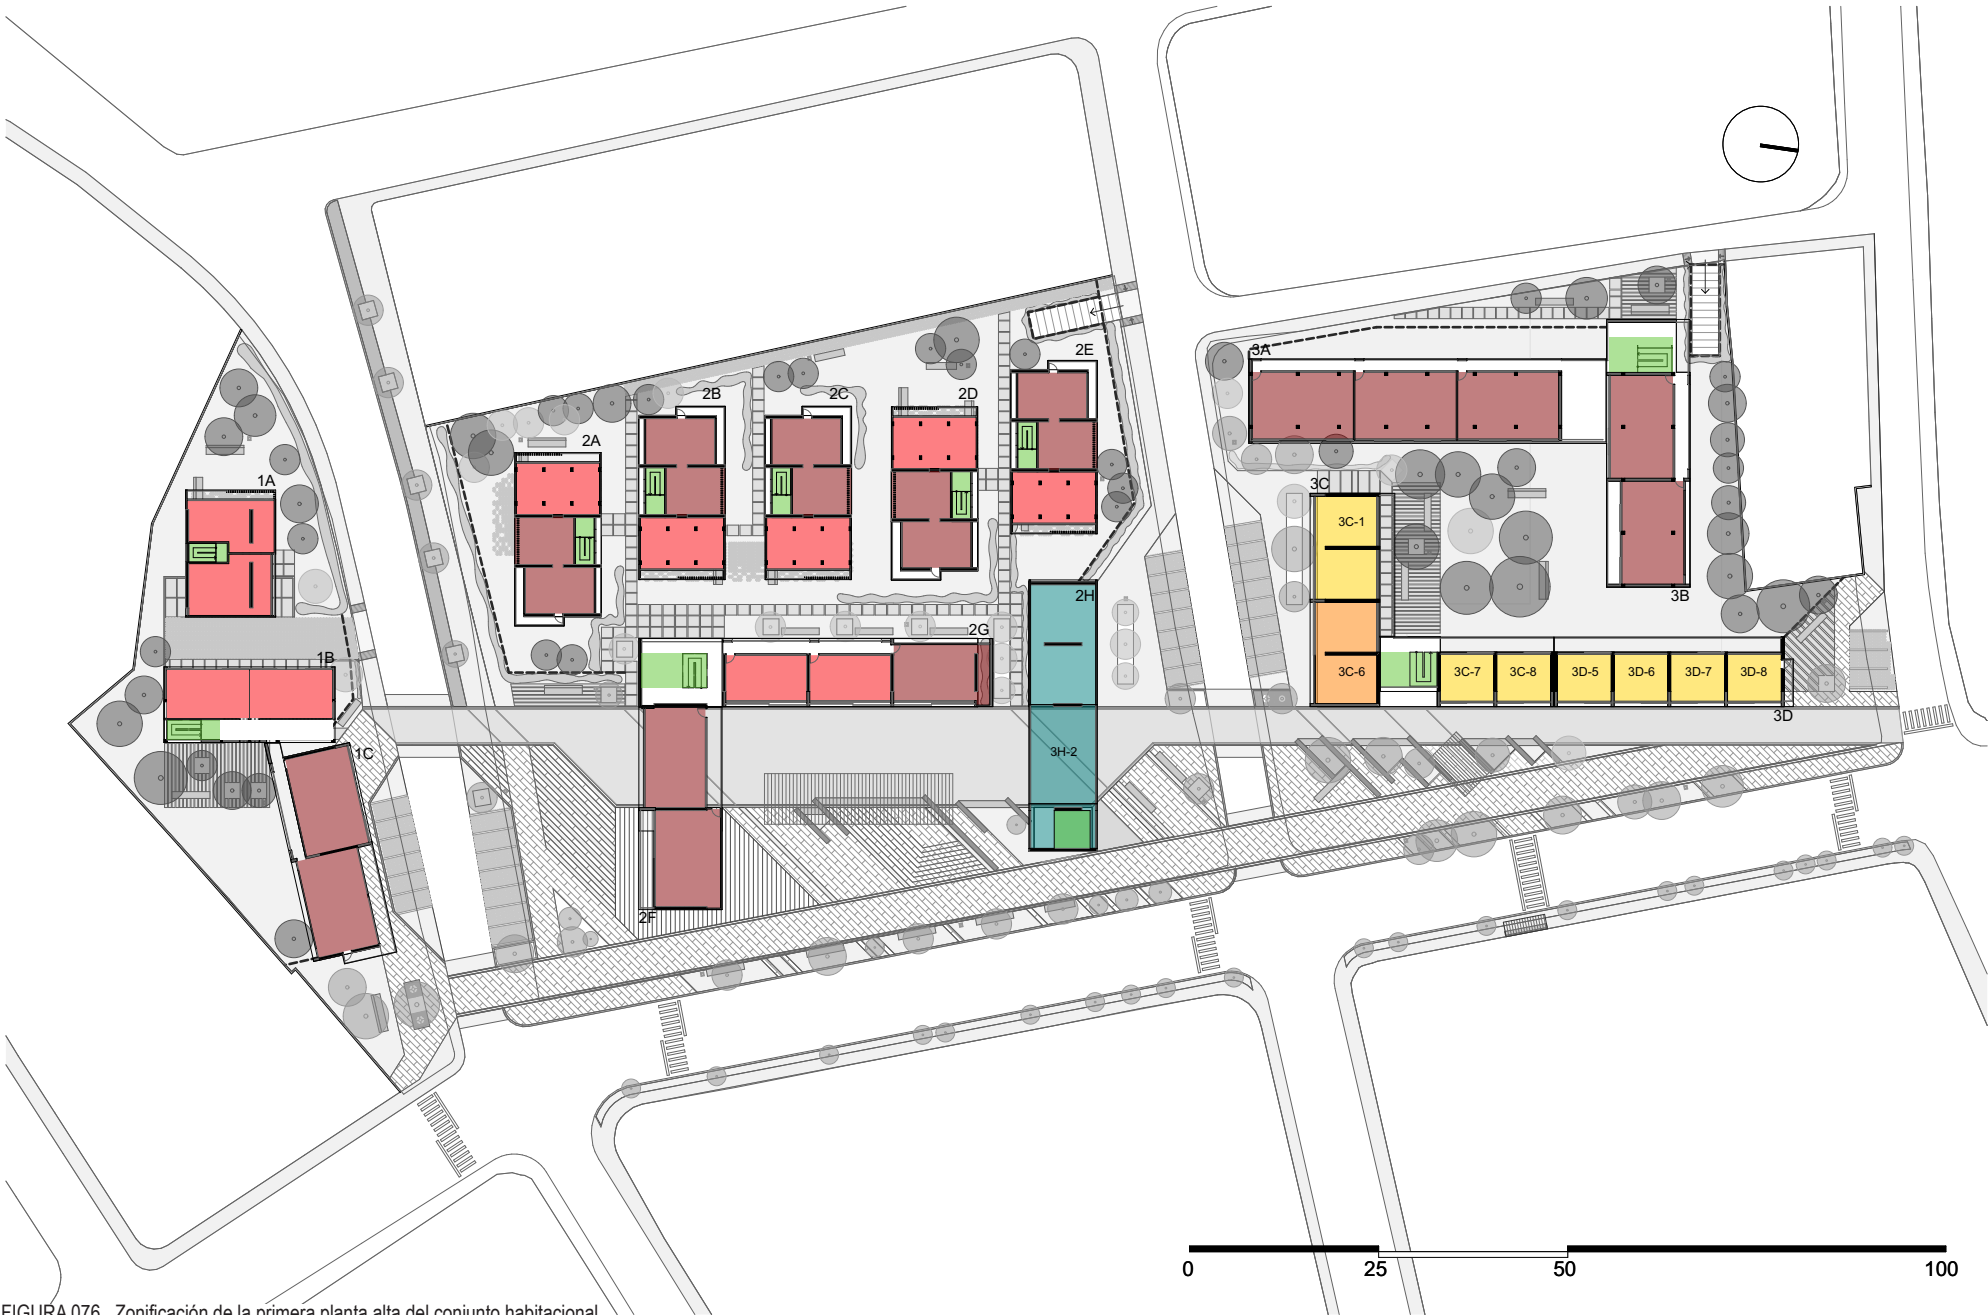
\_ Zonificación de la primera planta alta del conjunto habitacional
